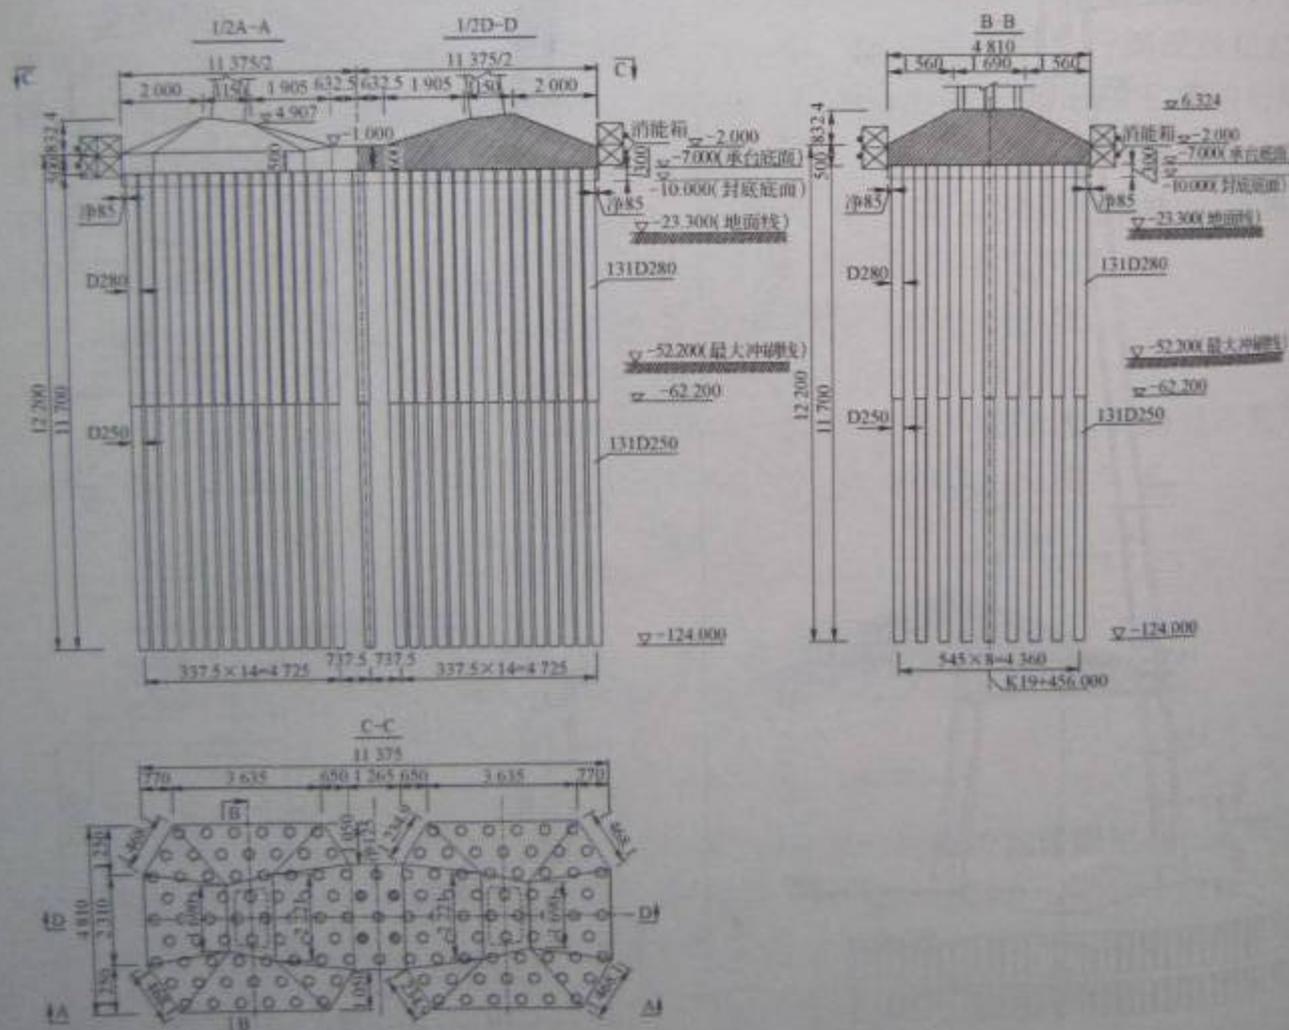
主塔基础一般构造图(尺寸单位:高程:m,其他:cm)
